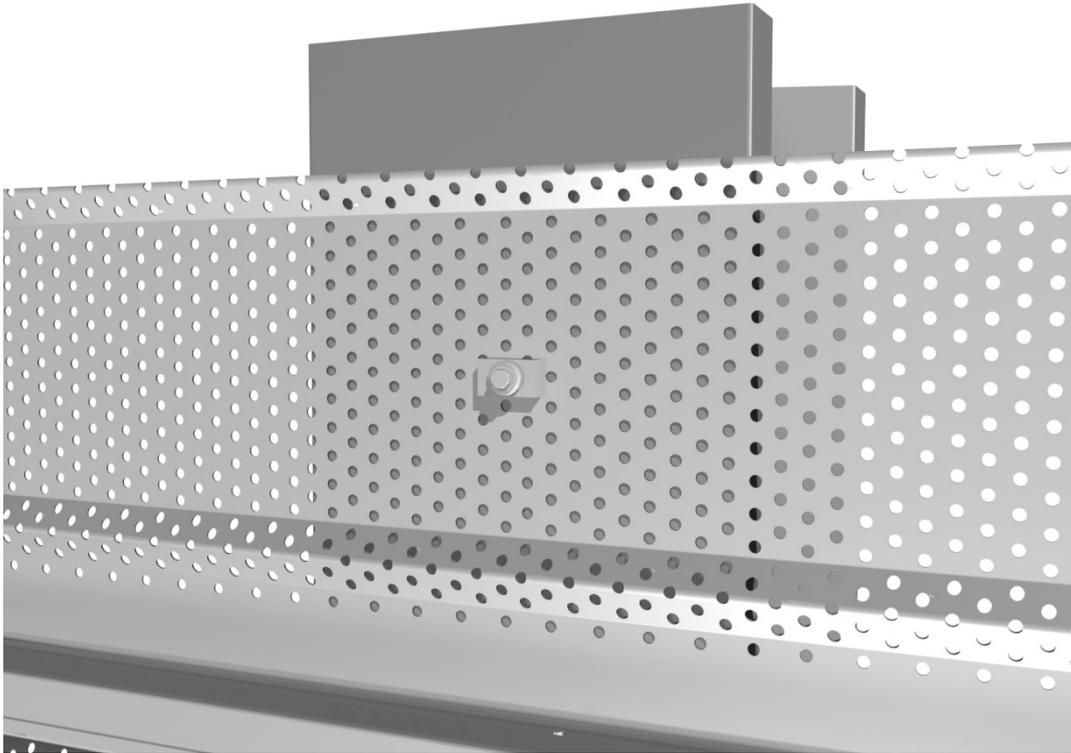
Fractionnement de lame d'air – Coupe verticale
